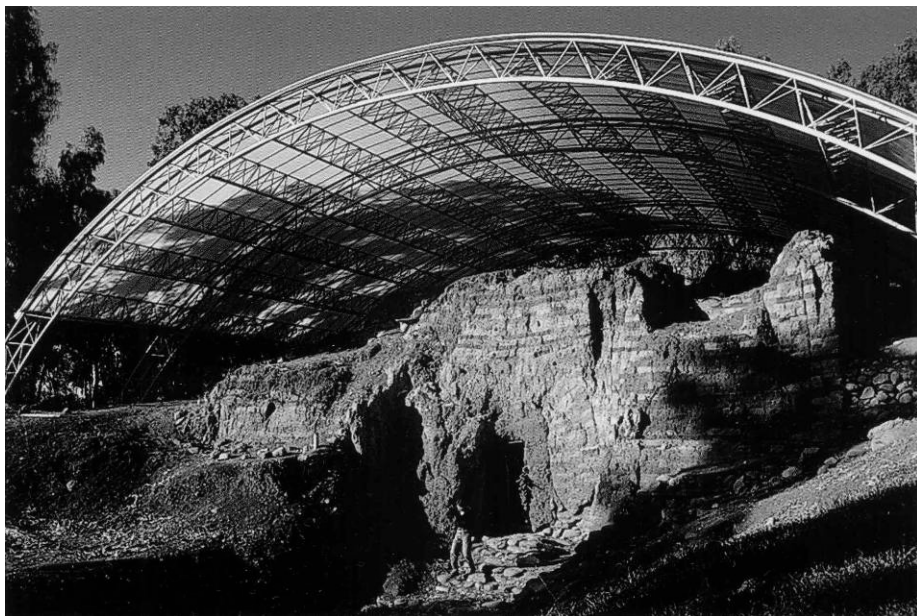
Zaštitna konstrukcija iznad terme, Viminacium
